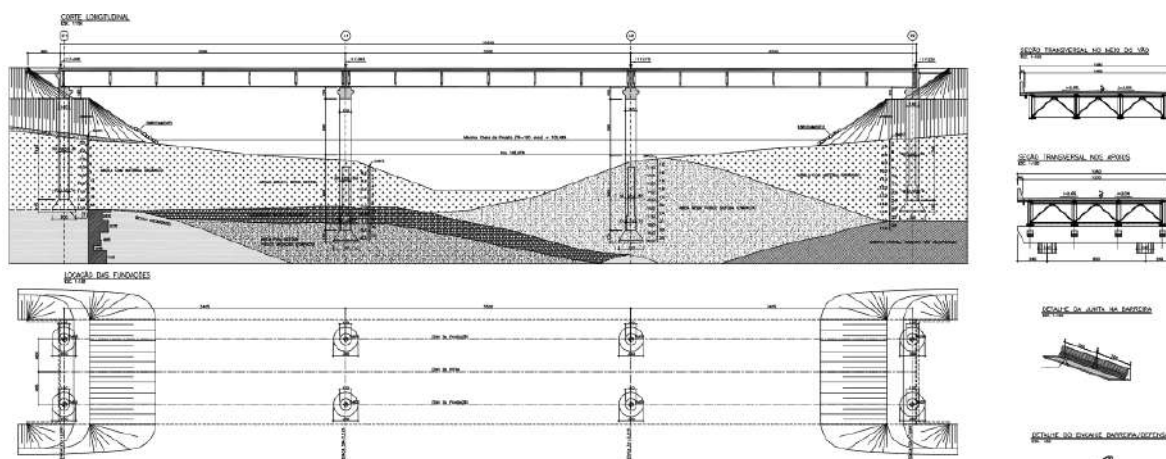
Esquemático de Projeto de Ponte Mista Metálica sobre o Rio Araras – DNIT – BR425
